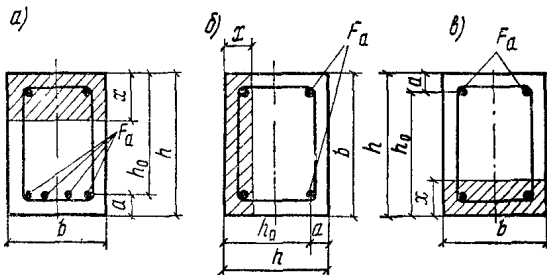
Расчетные схемы расположения сжатой зоны пространственного сечения
